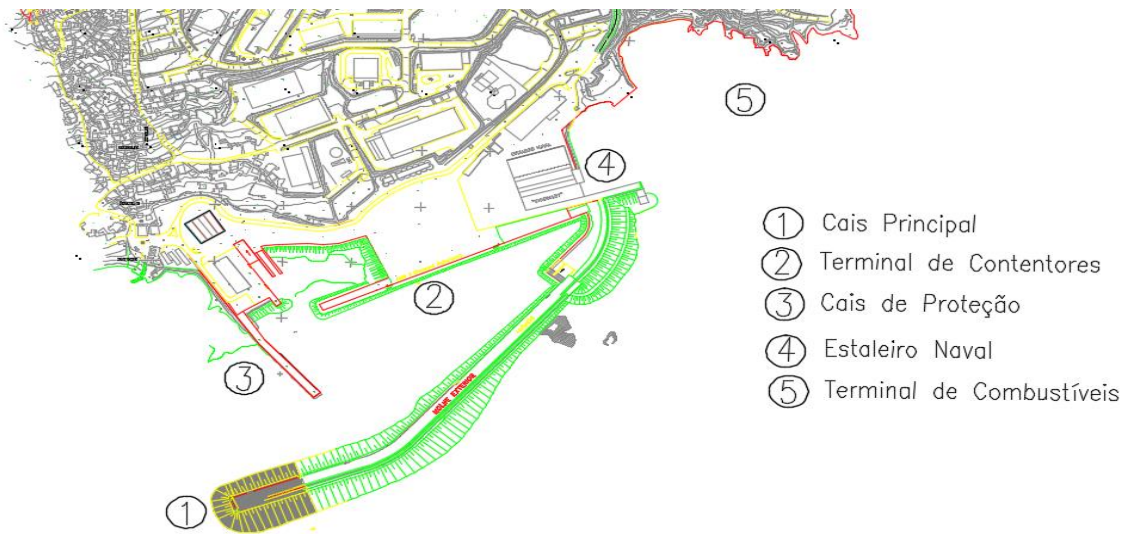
Planta do Porto do Caniçal (APRAM, 2018).
